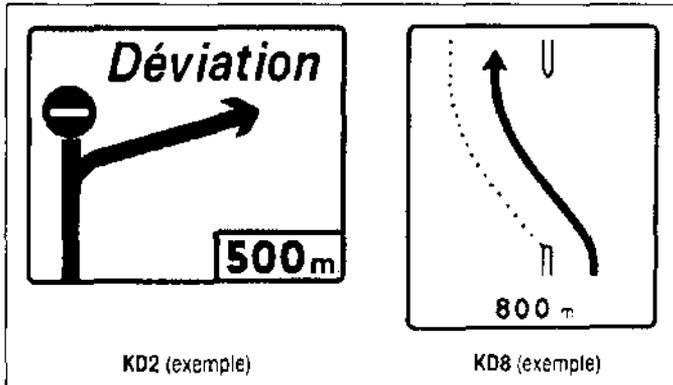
Détournement de la circulation (exemple : KD 2), changement de chaussée (exemple : KD 8).
